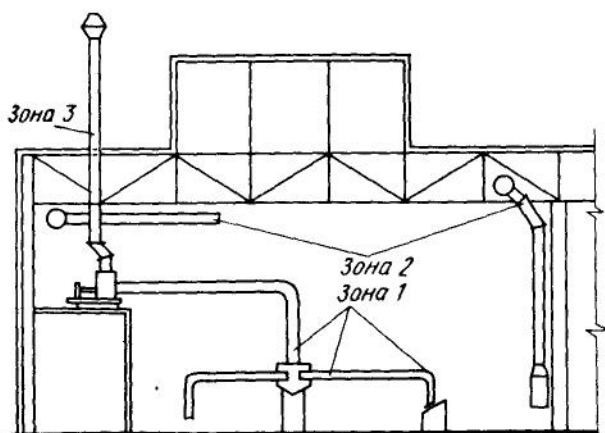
Разбивка на зоны монтажа вентиляционных устройств промышленного здания
